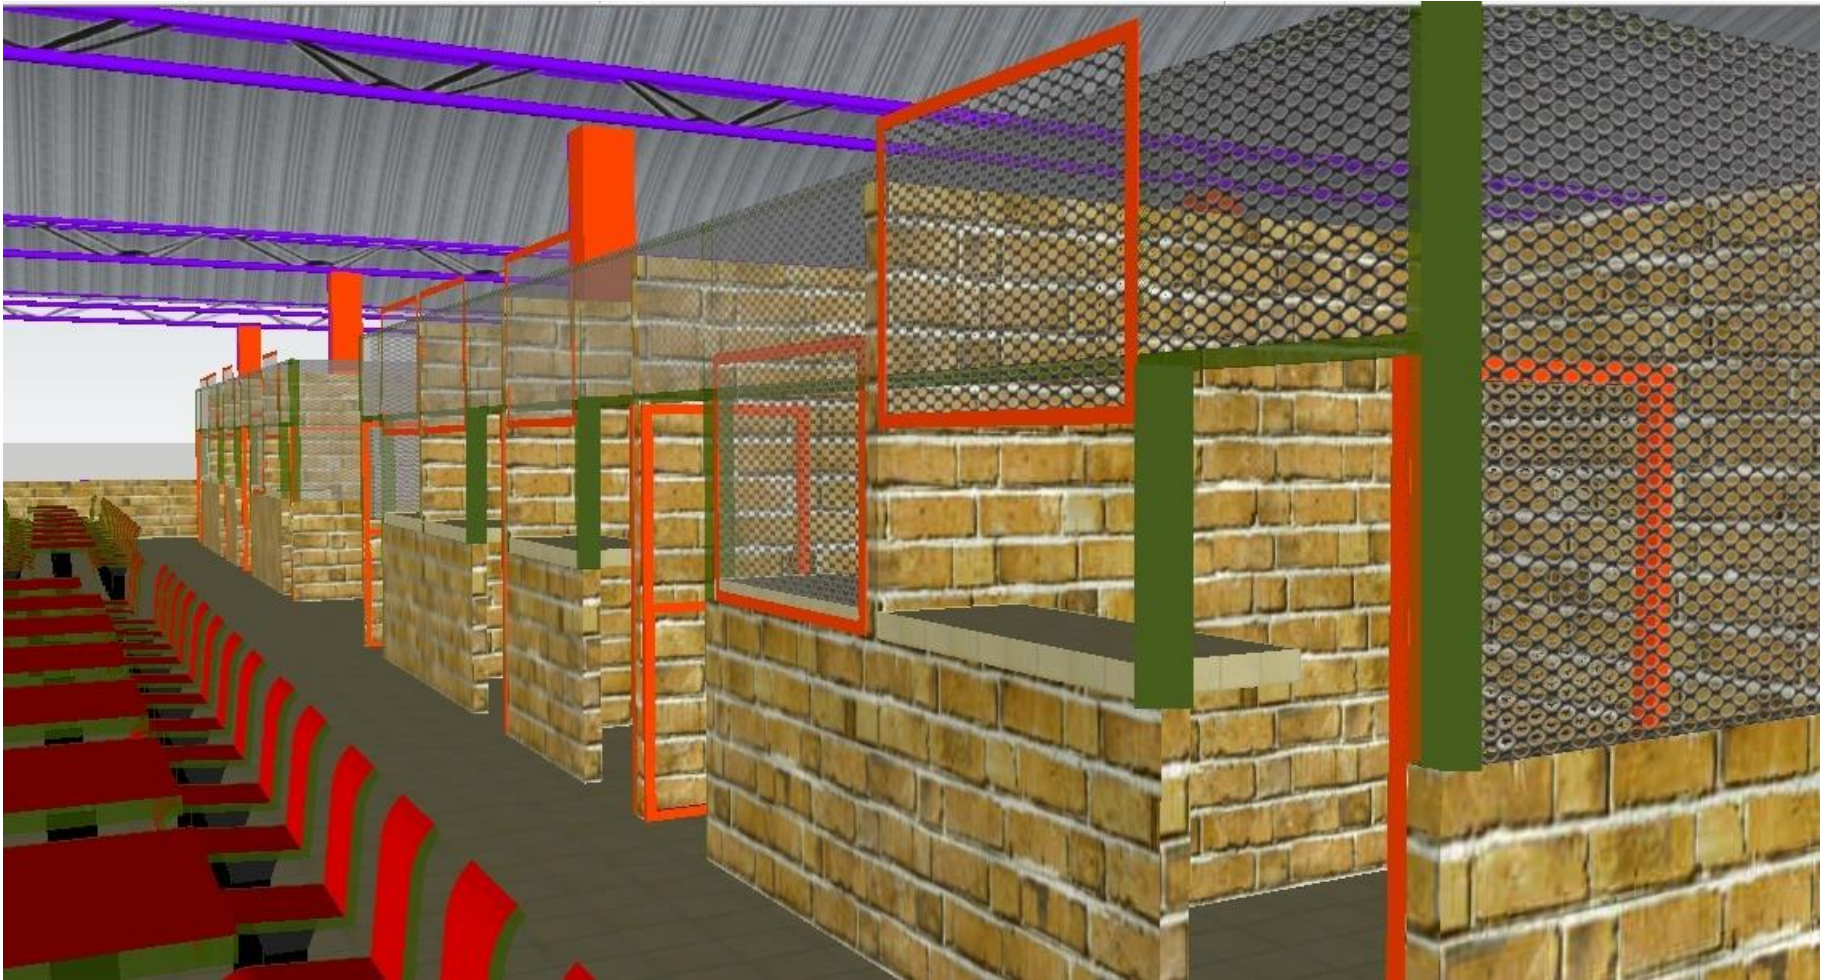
Vista interior de segundo nivel, en primer plano puestos de Pupusería a la izquierda zona de mesas, al fondo pared baja.
